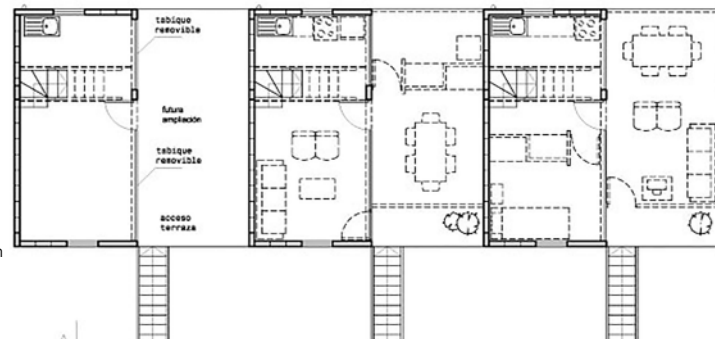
Vivienda Planta Baja con proyección de ampliación.
